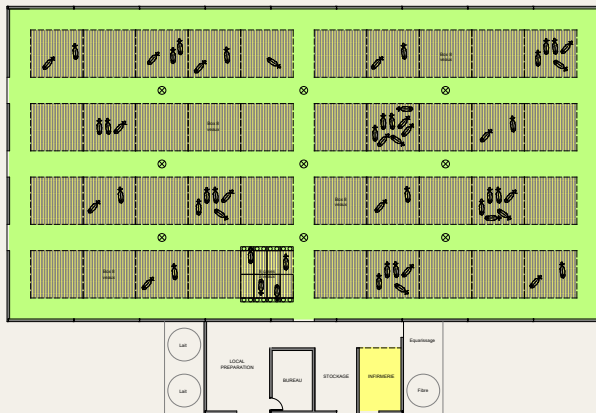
VUE EN PLAN D'UN BÂTIMENT TYPE TUNNELS DE VEAUX DE BOUCHERIE EN CAILLEBOTIS
